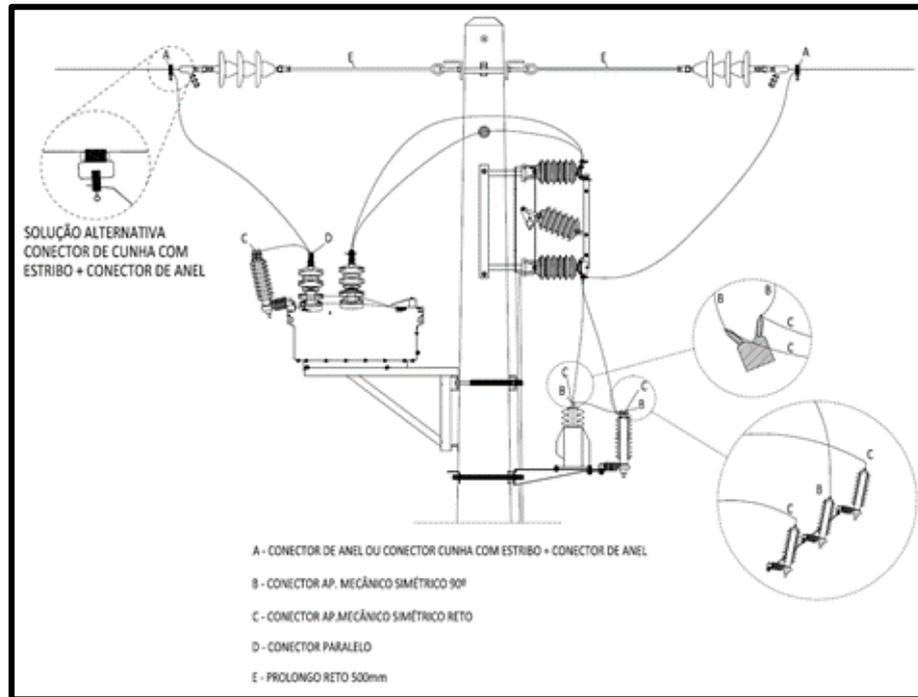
Montagem de seccionador em apoio com 'OCR'
